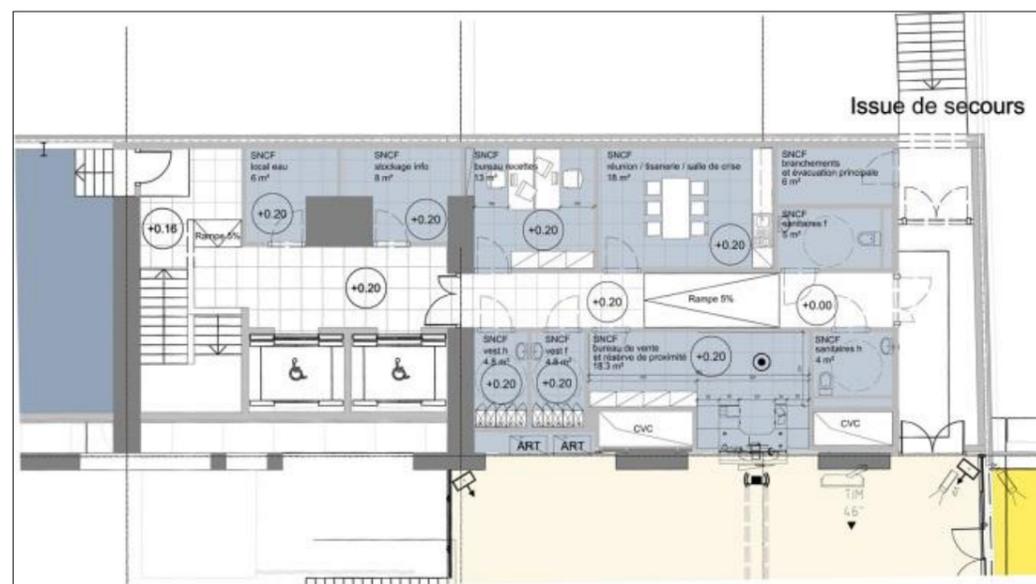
Ardoines - Plan d'aménagement du guichet SNCF et back office attenant - Plan AVP
